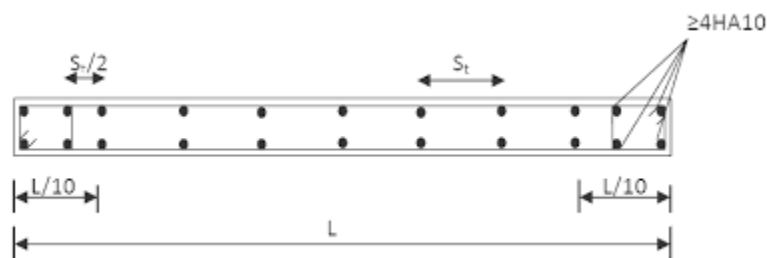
Disposition des armatures verticales dans les voiles.
